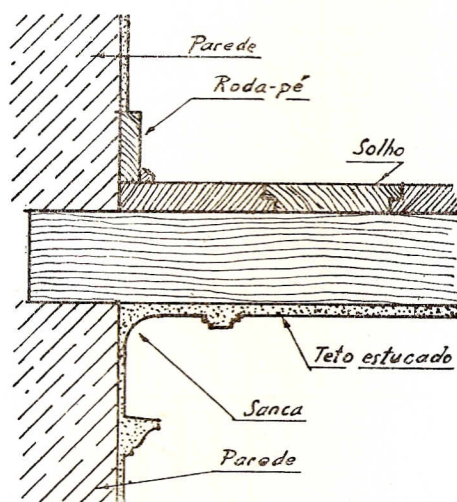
CORTE DE TECTO ESTUCADO E DO PAVIMENTO SUPERIOR
